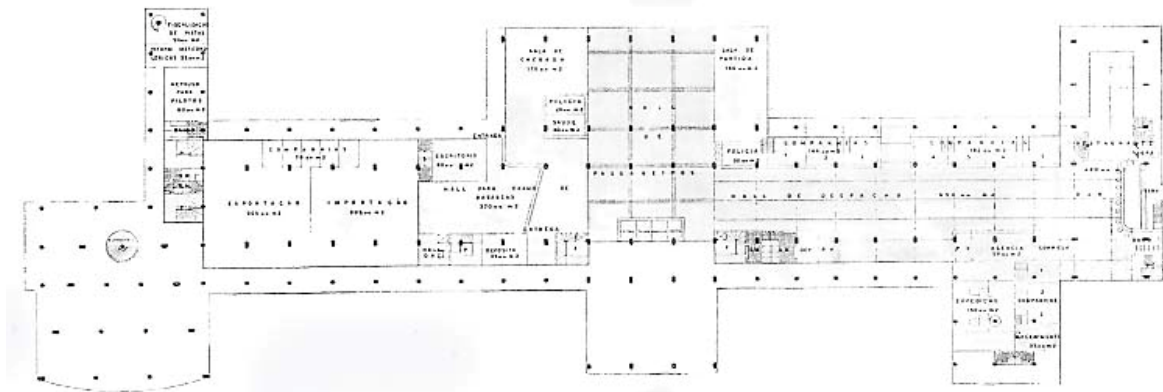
Anteprojeto de Lima, Almeida e Santos - planta baixa do pavimento térreo.
